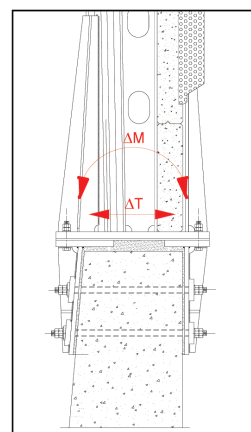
Caso particolare di collegamento di un montante di una barriera antirumore sull'opera d'arte, ad esempio su testa muro in cls. *Particular connection case of a noise protection barrier connection to the manifold, for example on the wall head in concrete.
